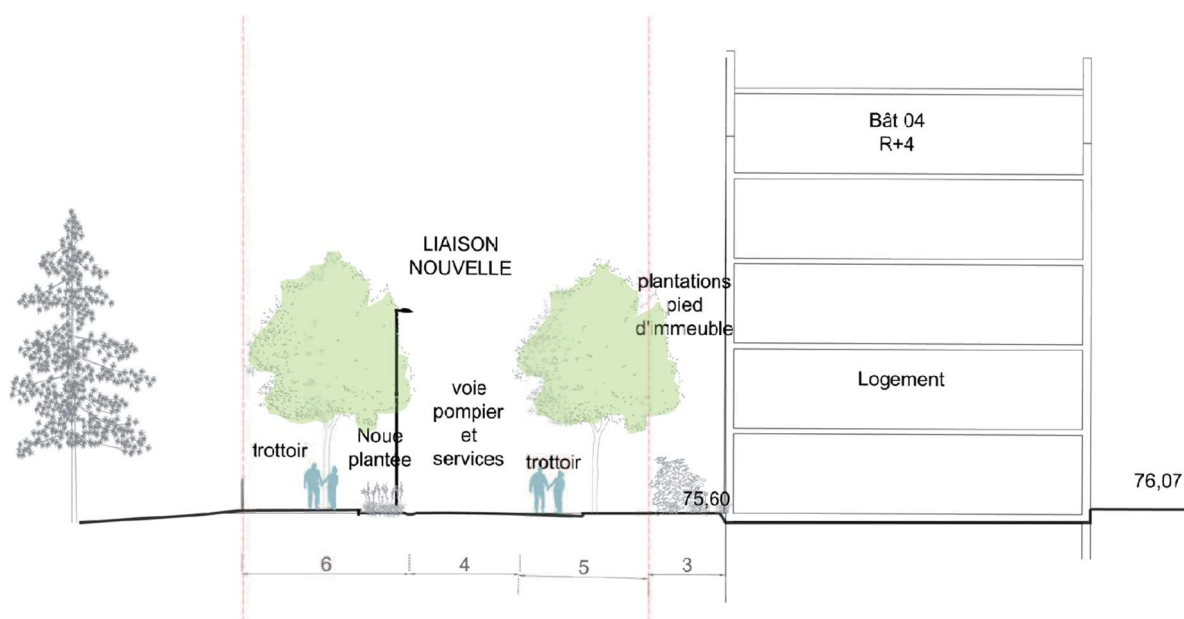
Profil en long de l'aménagement de la voie traversante est ouest.
